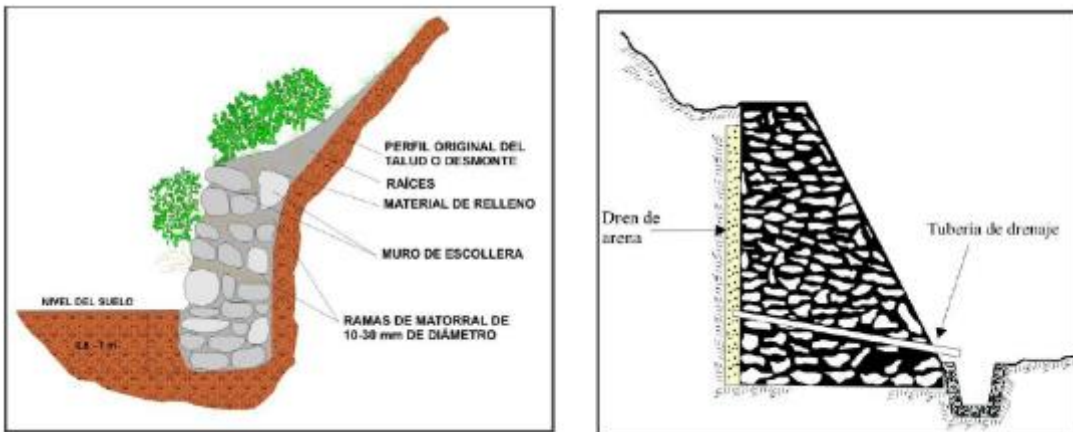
A). Muro de gravedad de piedra seca. B) Muros de gravedad de piedra argamasada.
